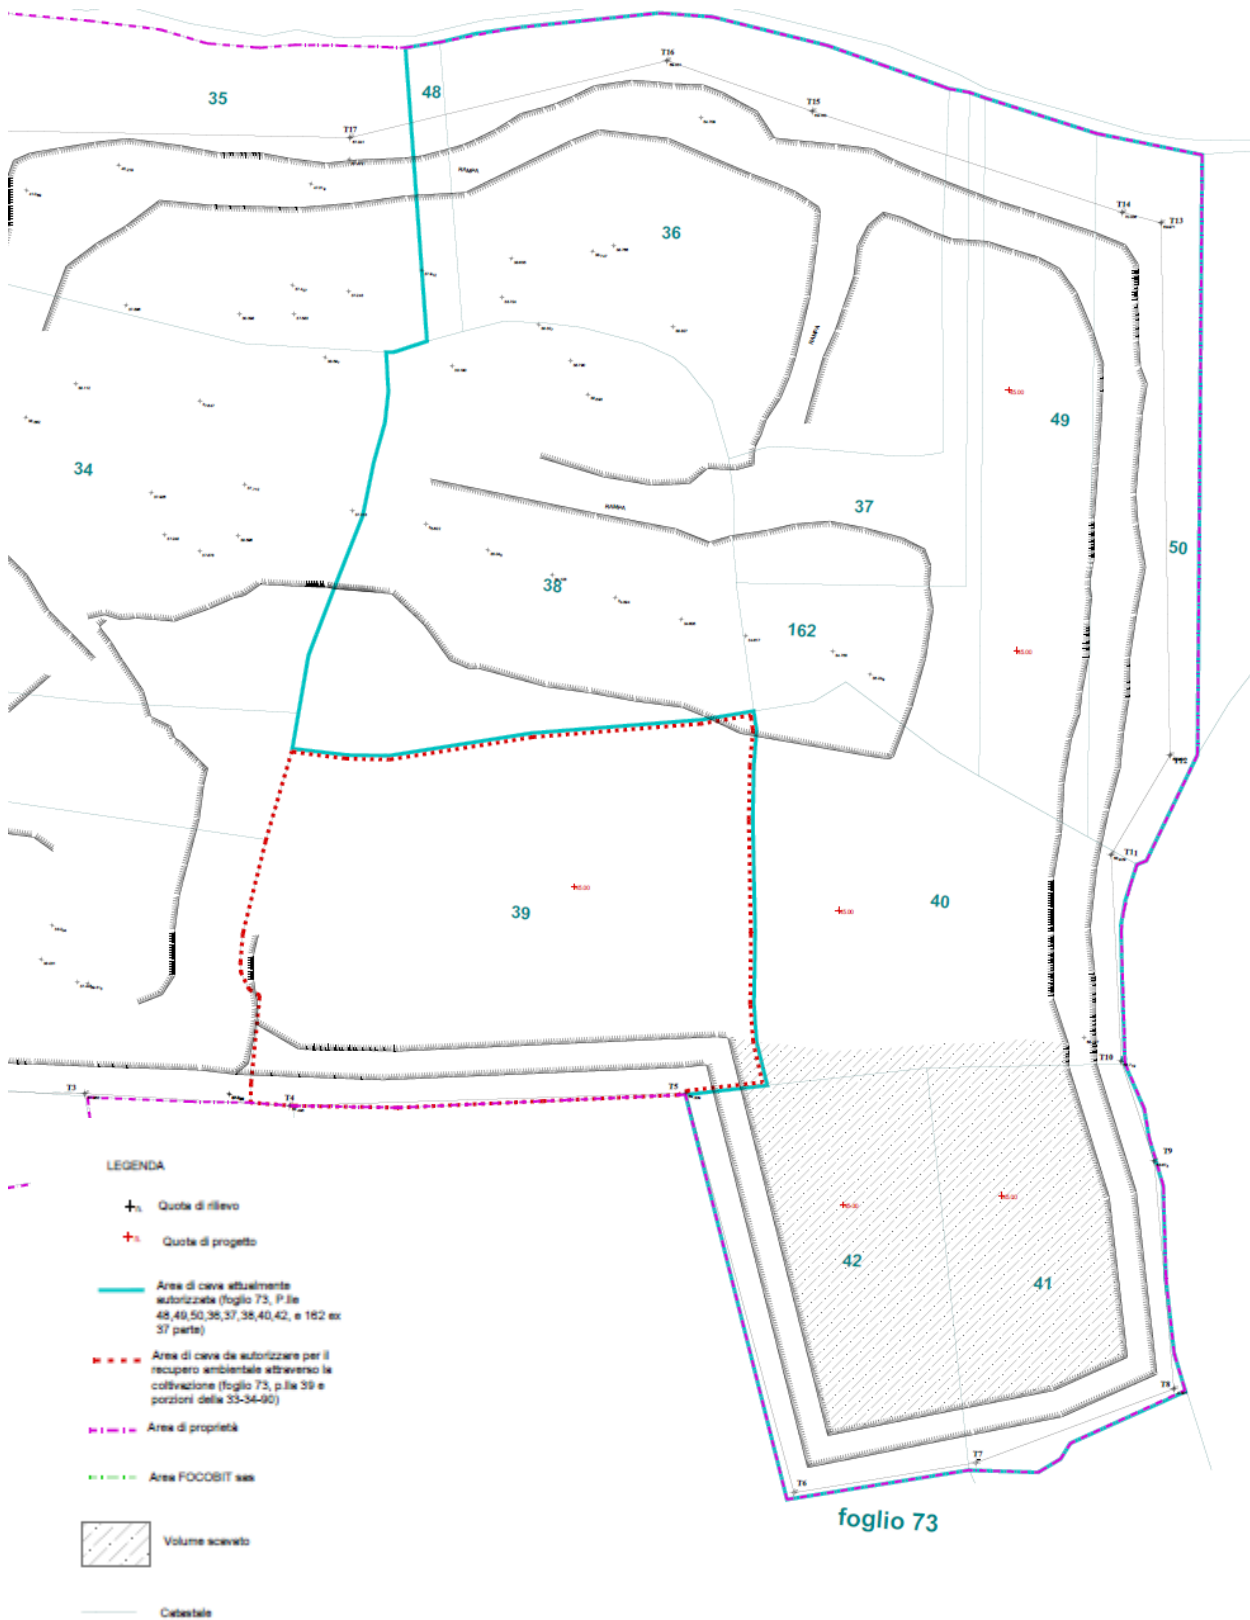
stralcio della Tavola TP4: Piano di Coltivazione FASE 4
